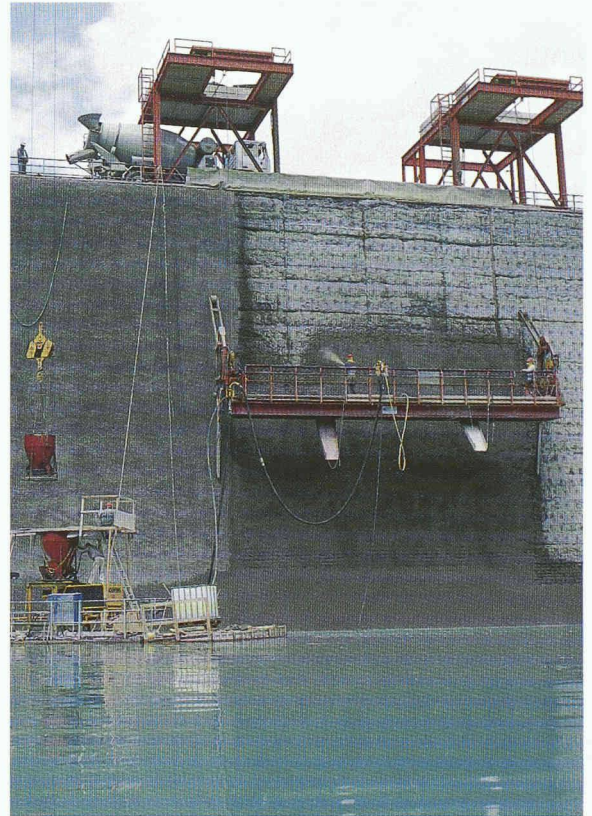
Equipement nécessaire à la projection du béton: pompe sur radeau, plate-forme de travail, portiques de suspension de la plate-forme, benne à béton, camion malaxeur
